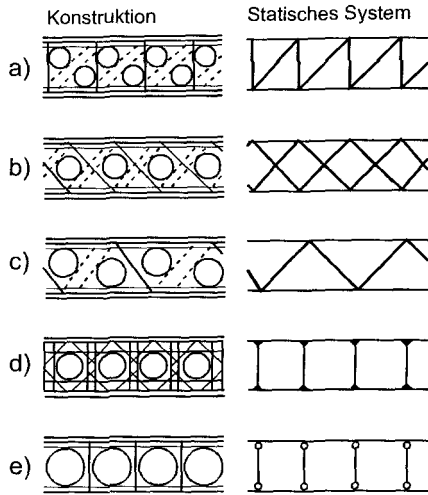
Konstruktionen und statische Systeme von Balken mit Aussparungsgruppen [66]
